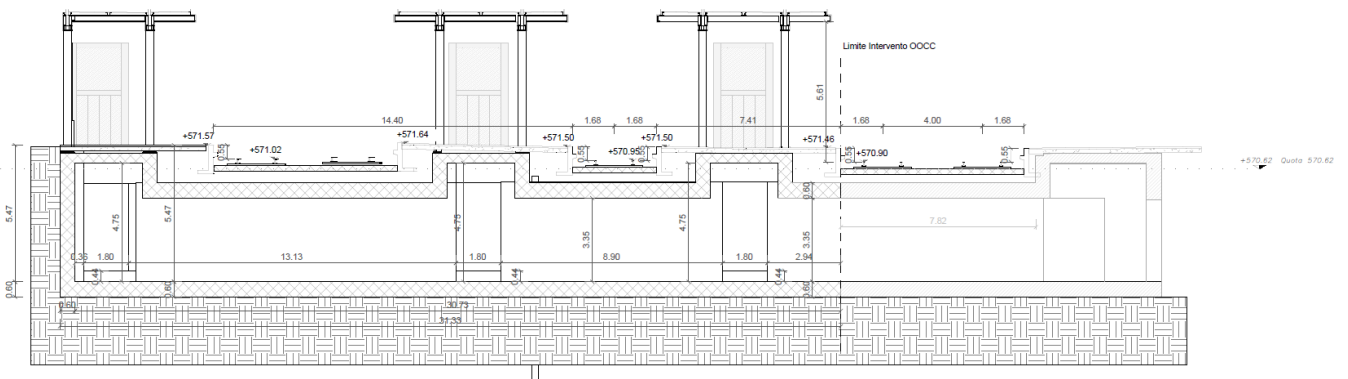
Nuovo sottopasso di stazione SL02 – Sezione longitudinale
